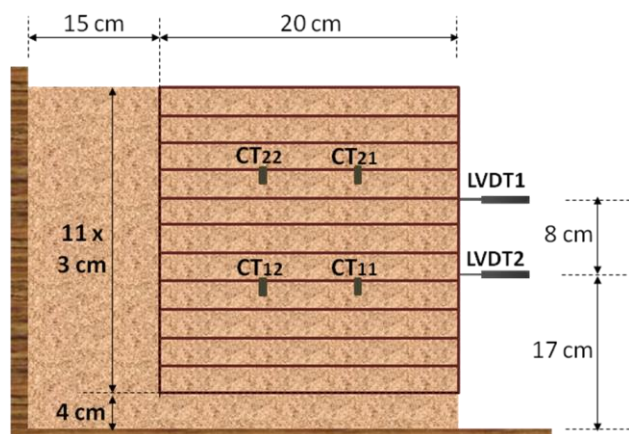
Corte longitudinal da caixa de ensaios (ensaio com reforço).
